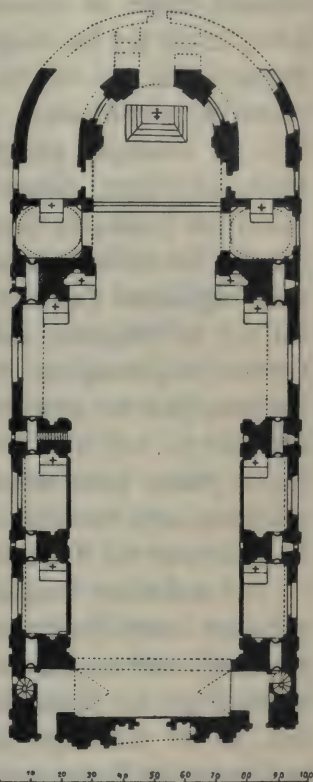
Bamberg. Martinskirche. Grundriß. (Nach Hörmanns Kopie des Originalgrundrisses.)
